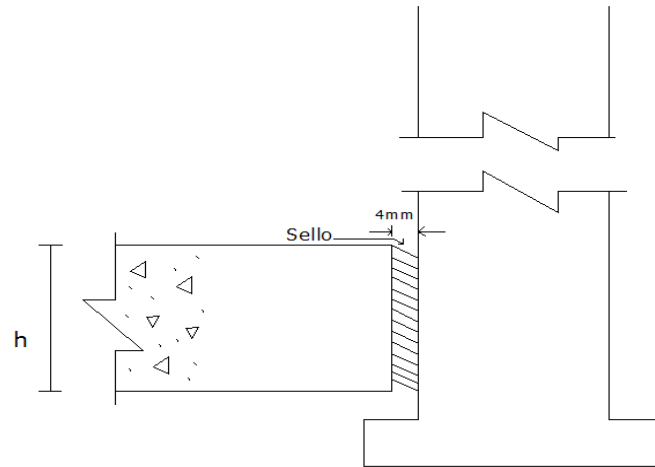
Junta de expansión para pavimentos rígidos.
